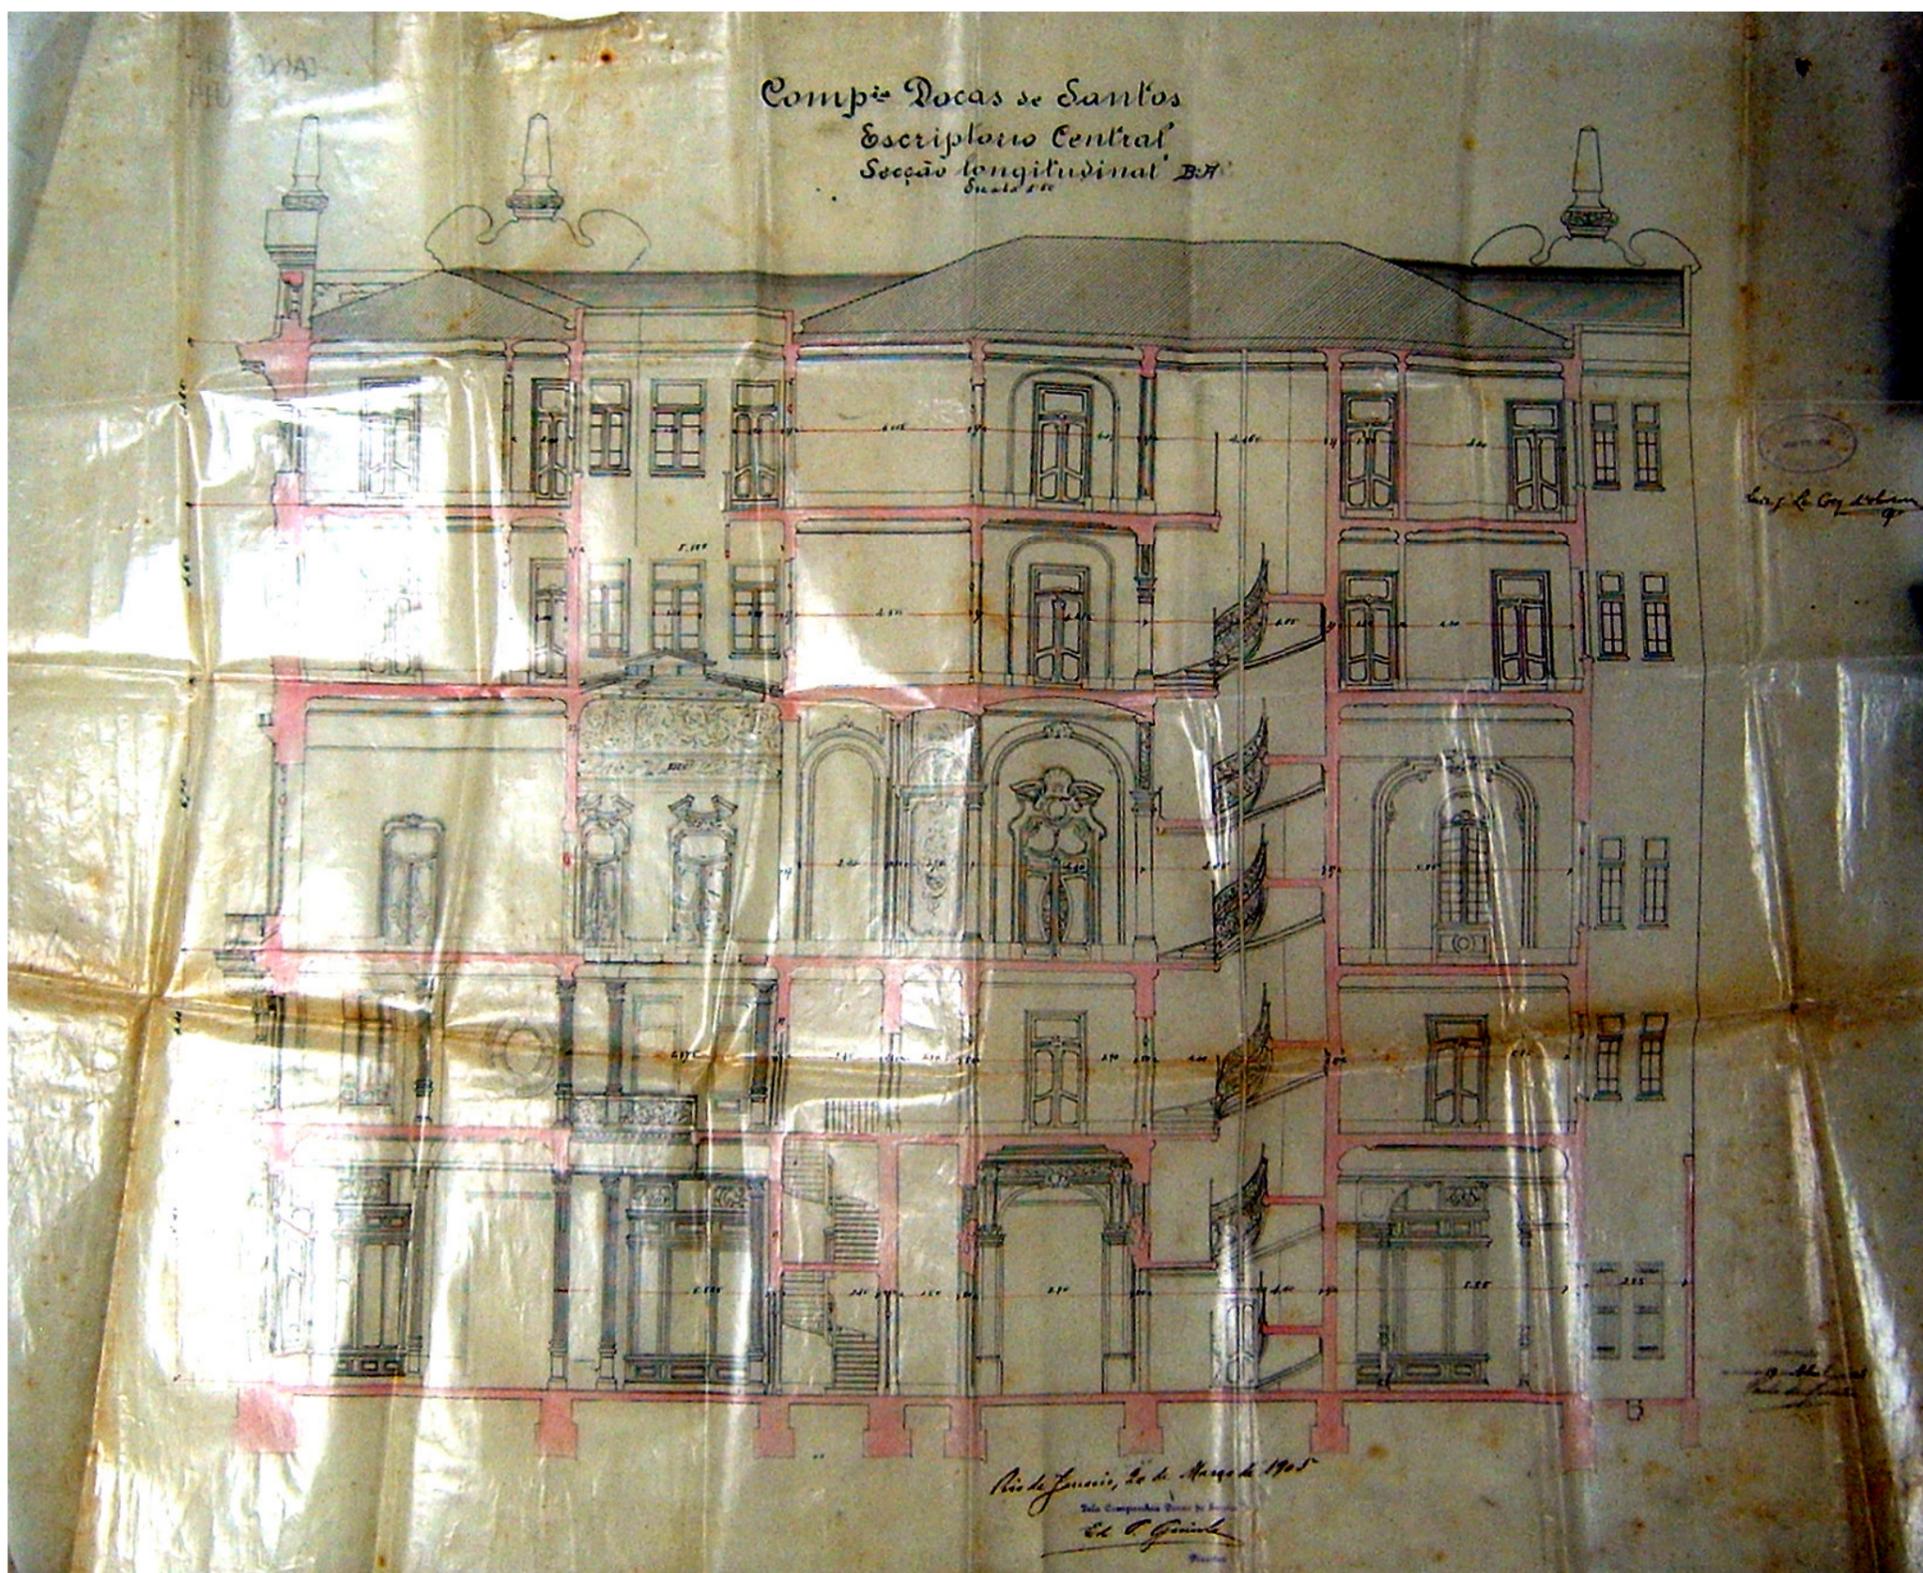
Corte longitudinal do projeto da edificação de nº 44 a 48, para a C.ia Docas de Santos. Projeto do escritório do arquiteto paulista Ramos de Azevedo. Não consta do projeto, representação gráfica dos elementos estruturais.
